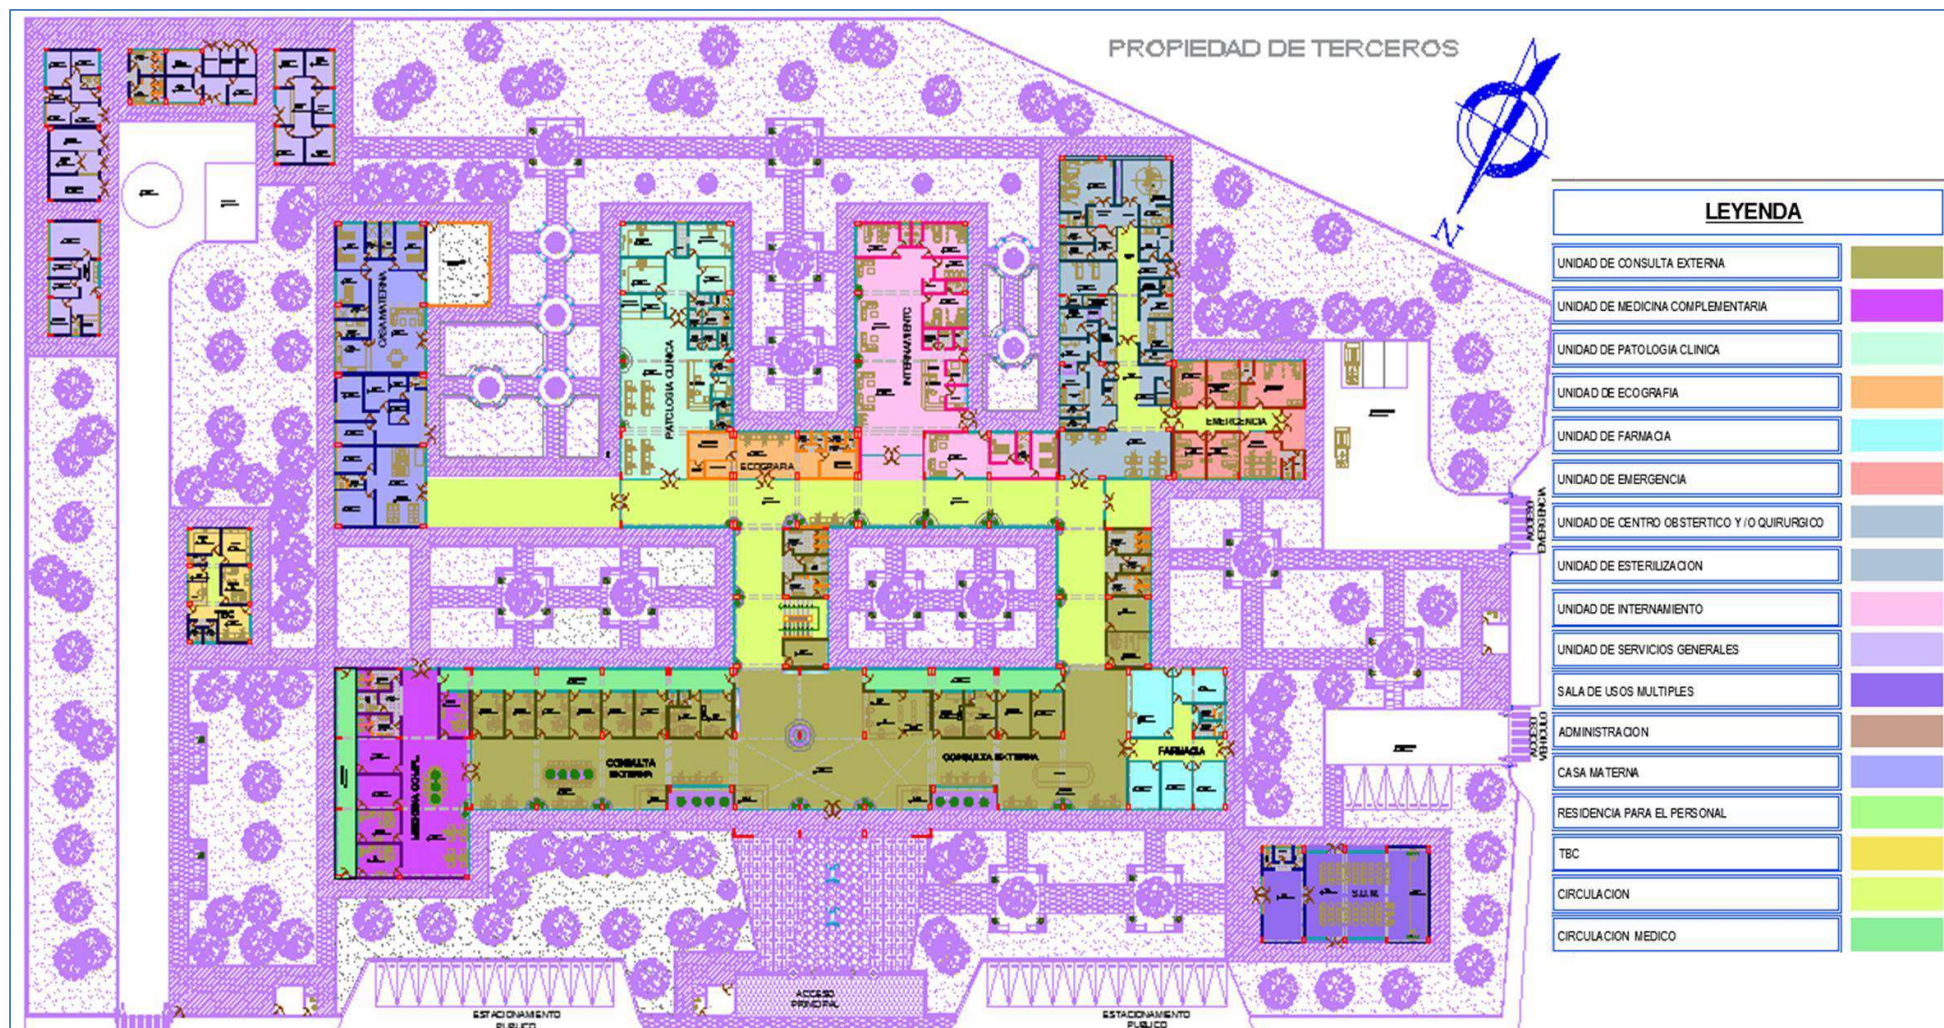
Zonificación 1° planta; Fuente: elaboración propia
